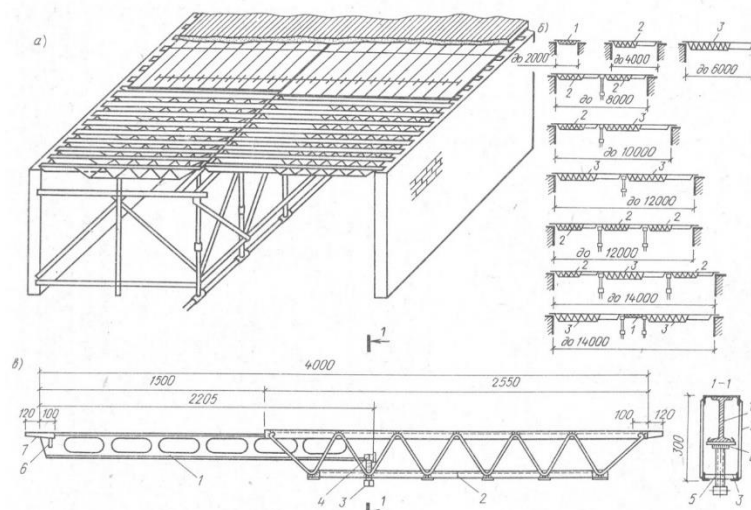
Схема устройства опалубки перекрытия; а – общий вид; б – схемы установки раздвижных ригелей; в – общий вид раздвижного ригеля РР-4; 1 – выдвигная балка; 2 – объемная ферма; 3 – соединительный винт; 4 – опорная обойма; 5 – гайка; 6 – пластина жесткости; 7 – опорная пластина.
